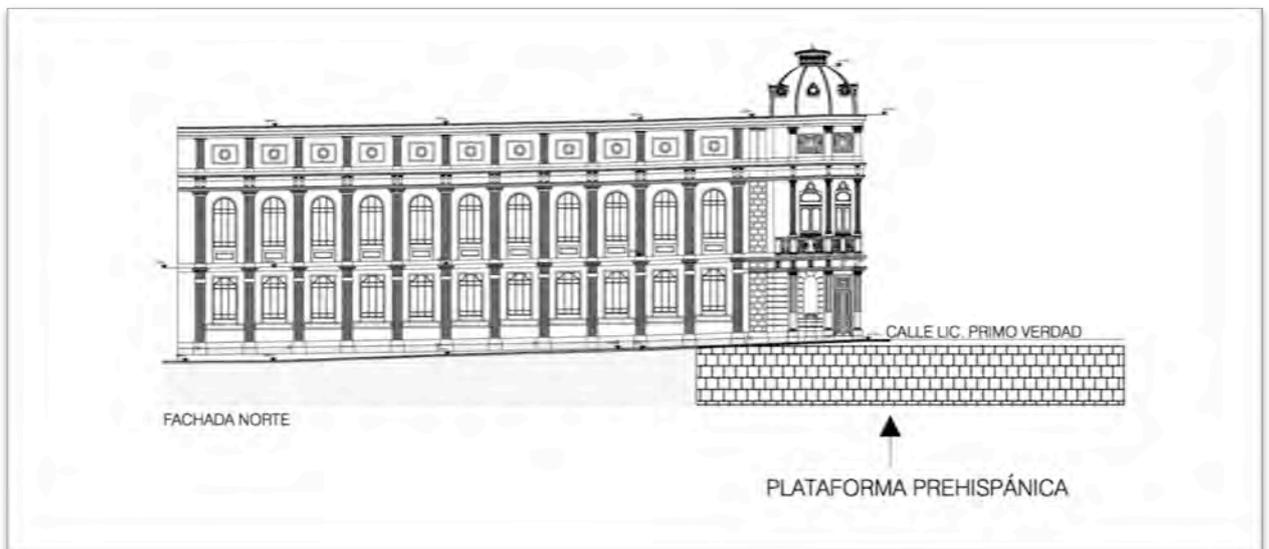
Planta Arquitectónica con la plataforma prehispánica.
